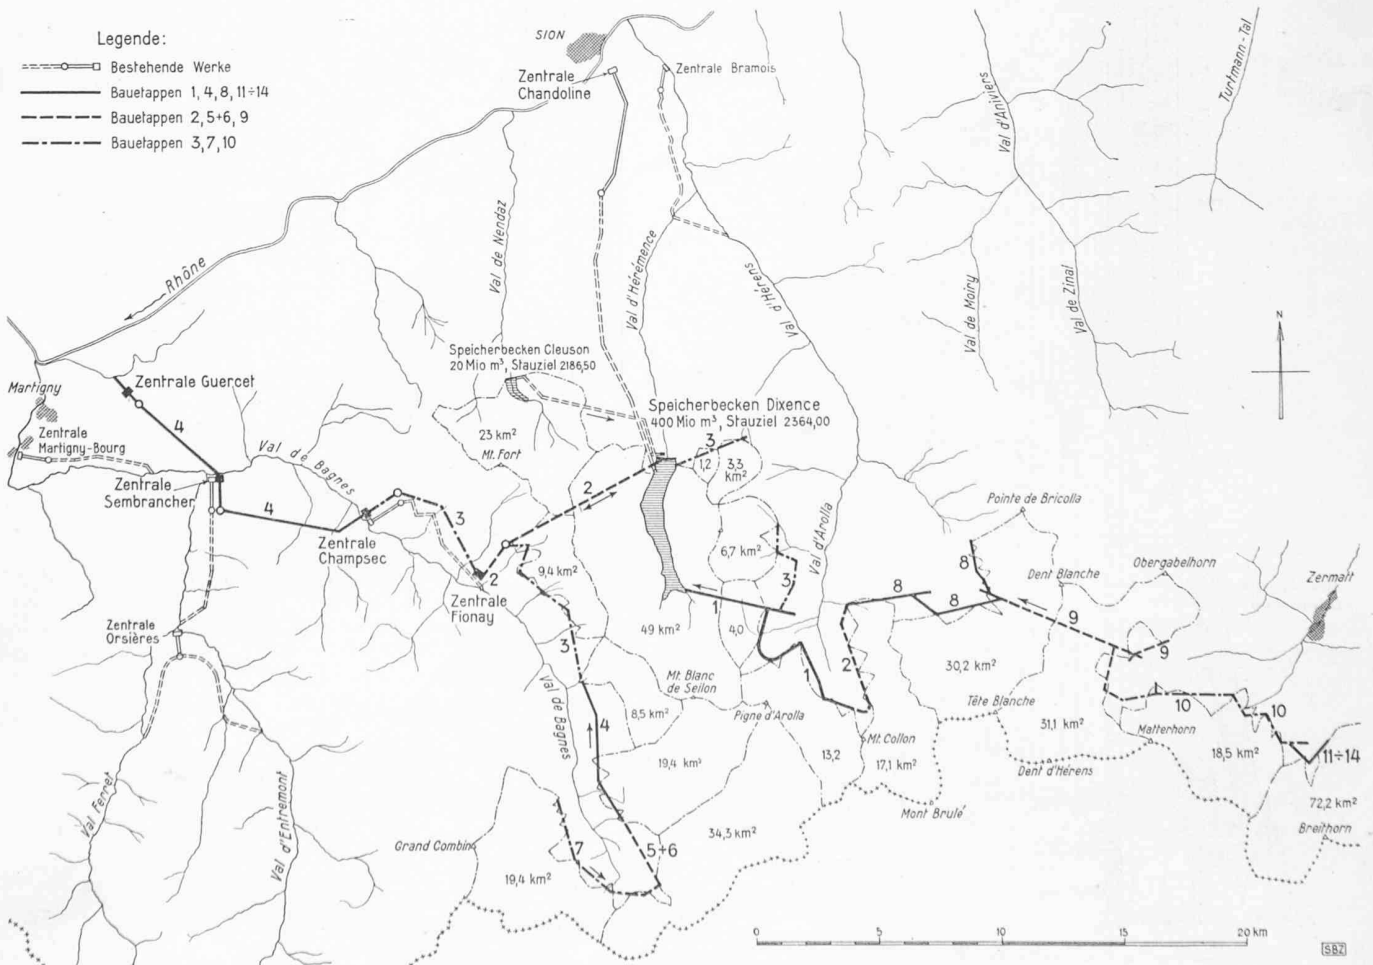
Speicherwerk Gross-Dixence, Lageplan mit Einzugsgebiet und etappenweisem Ausbau der Anlagen, Masstab 1:30000
